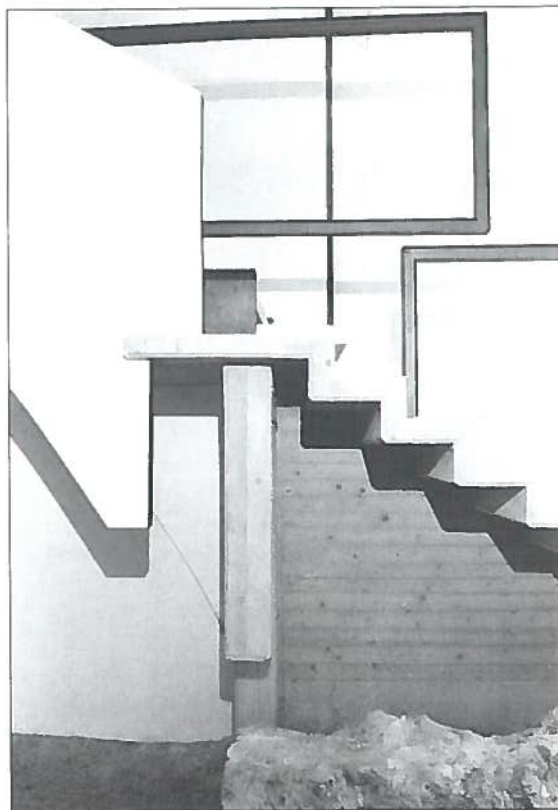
Restauro del Convento francescano dei Minori Conventuali a Sora. Dettaglio della rampa in cemento armato e del parapetto della scala che collega il piano terra, in corrispondenza degli spazi riservati alle esposizioni temporanee, con il primo piano.
